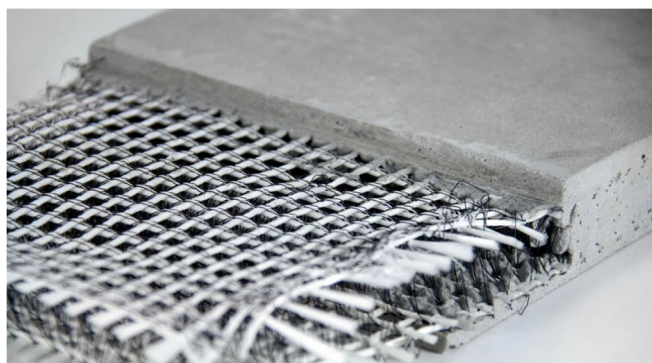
Текстильно-армированный бетон (ТАБ)
